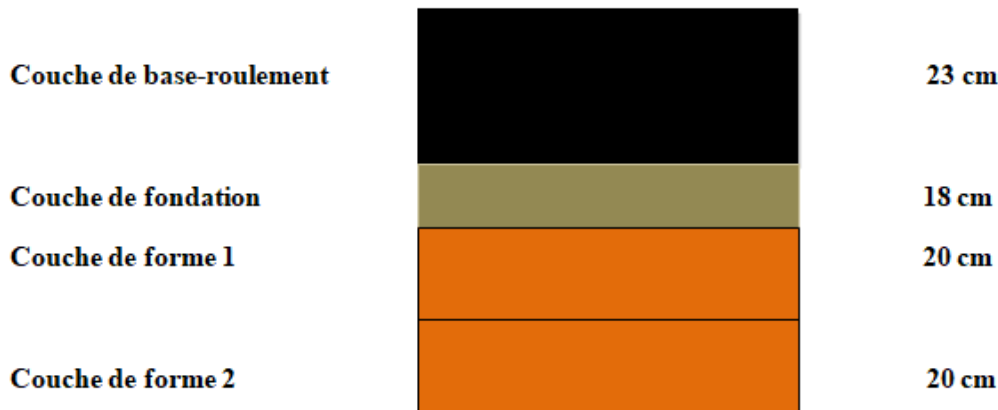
Différentes couches du corps de la chaussée rigide
